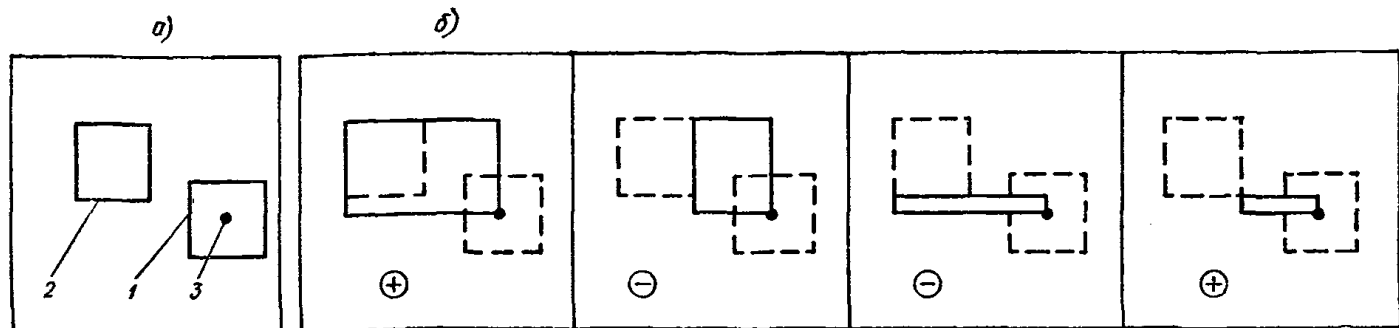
Схема расположения «фиктивных фундаментов» для учета влияния на осадку по методу угловых точек
